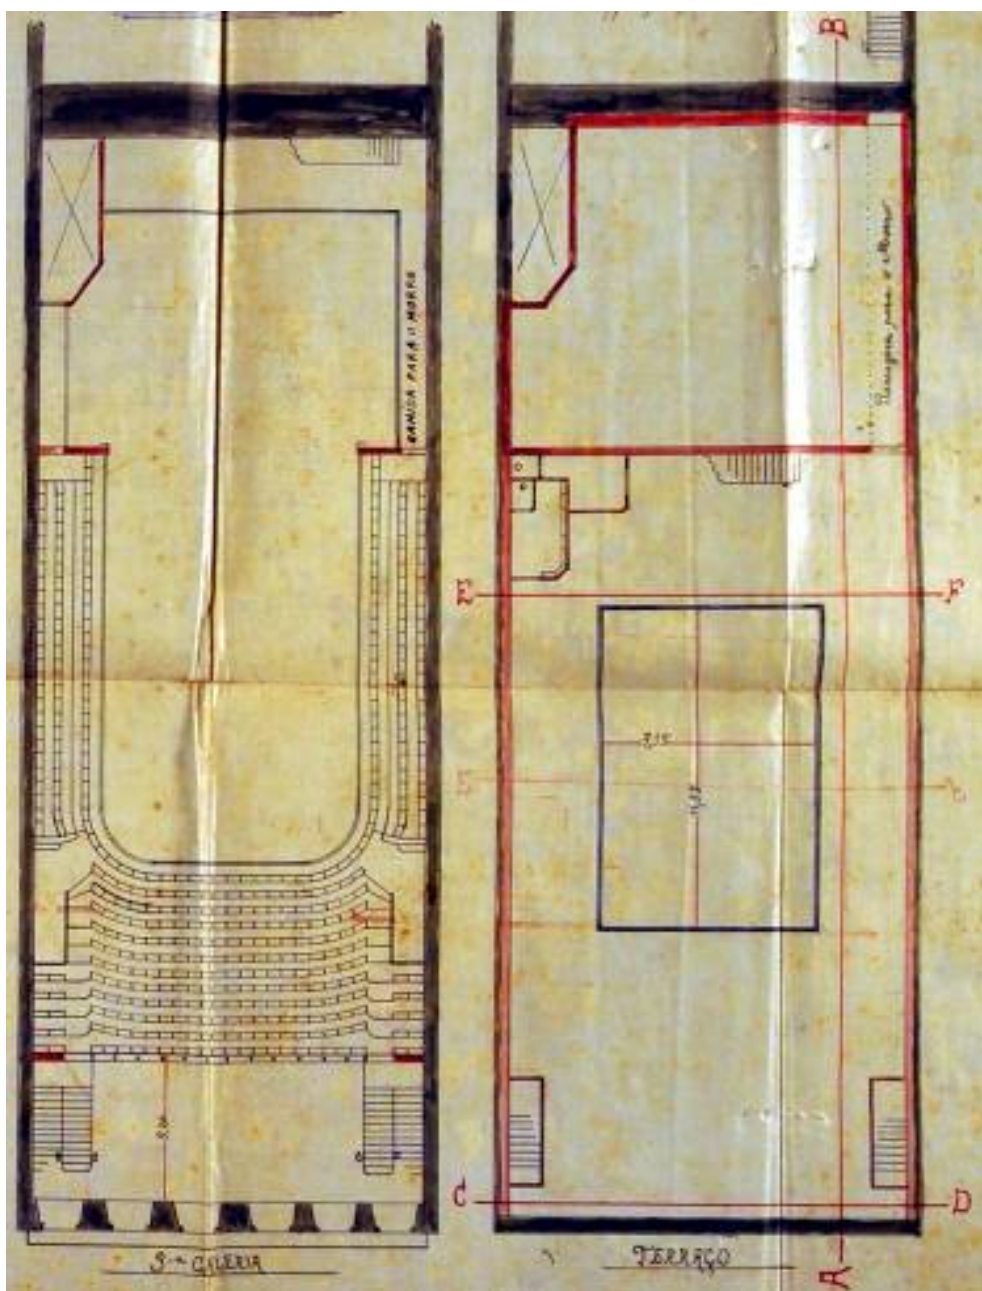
Plantas do segundo pavimento e cobertura. Fonte: AGCRJ.
